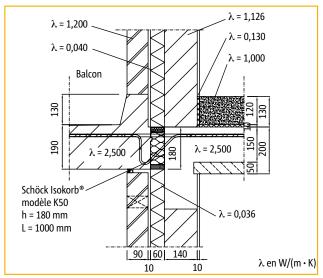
liaison d'une dalle de balcon avec le Schöck Isokorb® modèle K50
